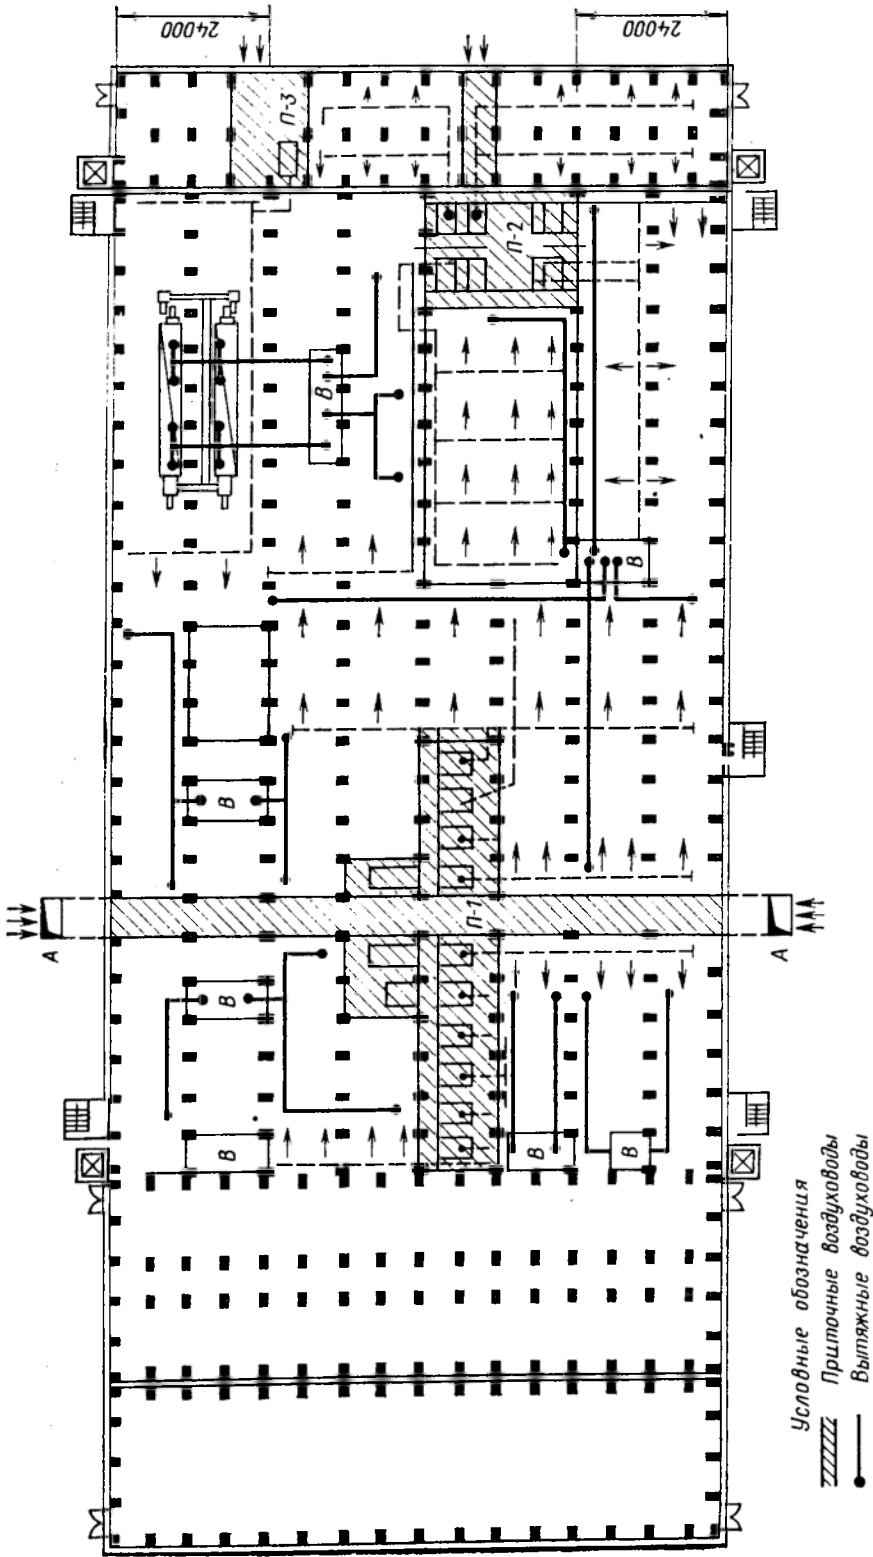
Схема расположения установок общедоменной вентиляции в двухэтажном здании литейного цеха: П-1 — приточная камера обслуживает помещения первого этажа и формовочно-заливочное отделение, размещенное на втором этаже. К камере воздух подается через отдельно стоящие воздухозаборные шахты и подпольные каналы; П-2 — приточная камера для смешериготовительного и грунтовочного отделений; П-3 — приточная камера для термообрубиного отделения; В — вытяжные камеры с системами очистки воздуха и выбросом через трубы; А — воздухозаборные шахты
